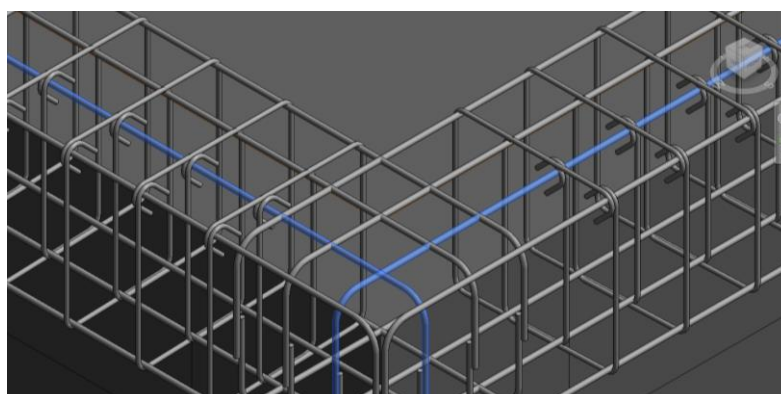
Pormenor de nó de ligação de duas vigas com interseção armaduras.
